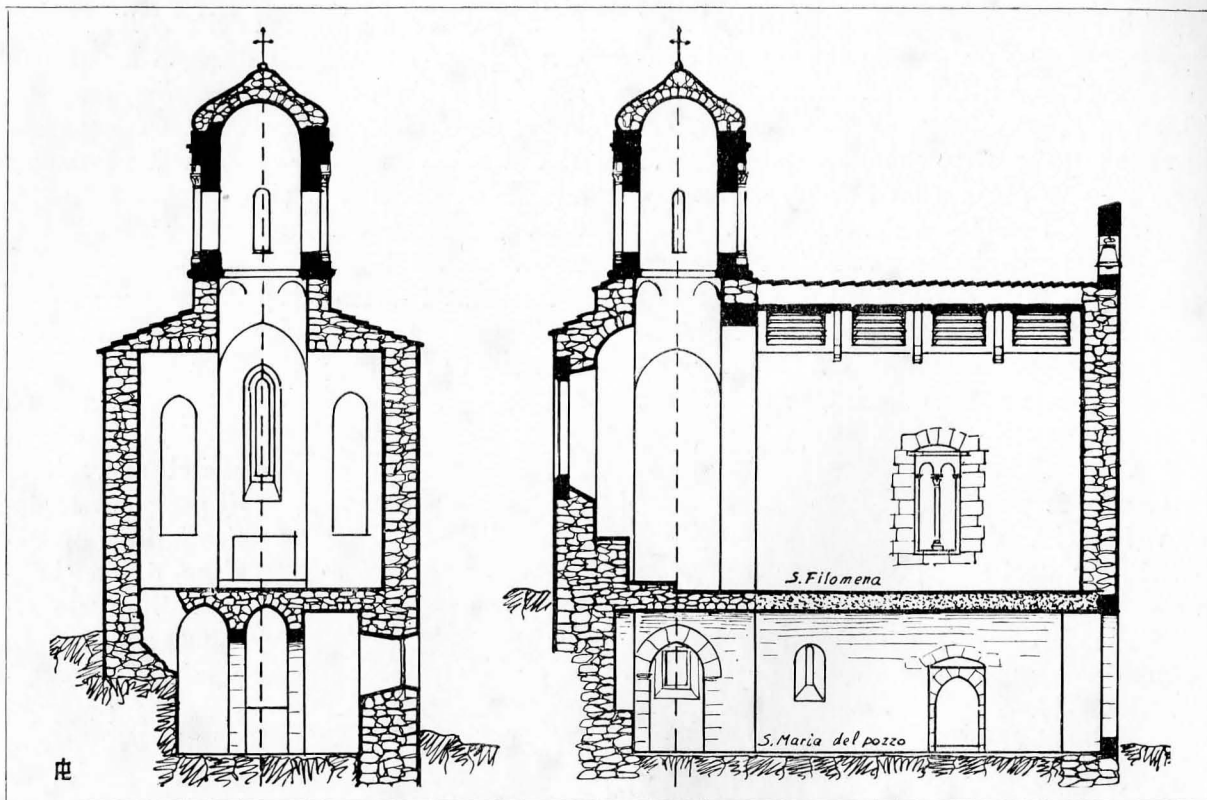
SANTA SEVERINA, CHIESETTA DI SANTA FILOMENA - SEZIONE LONGITUDINALE E TRASVERSALE
